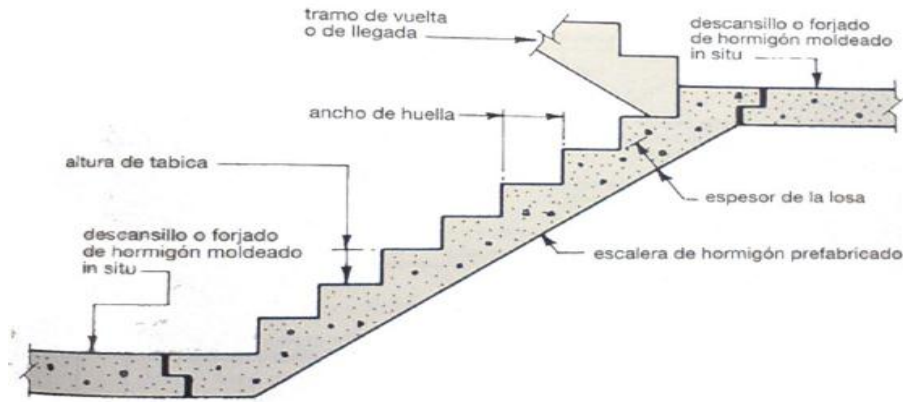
Armada típico de un Sistema de losa escalera de concreto
